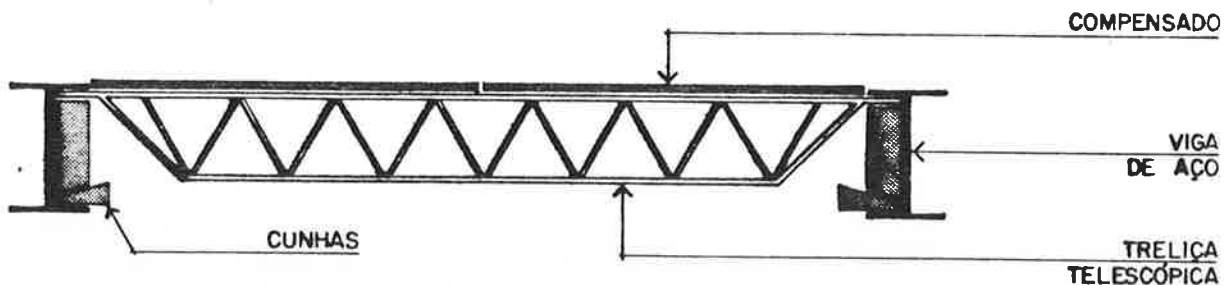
Treliça extensível apoiada diretamente nas vigas metálicas.
